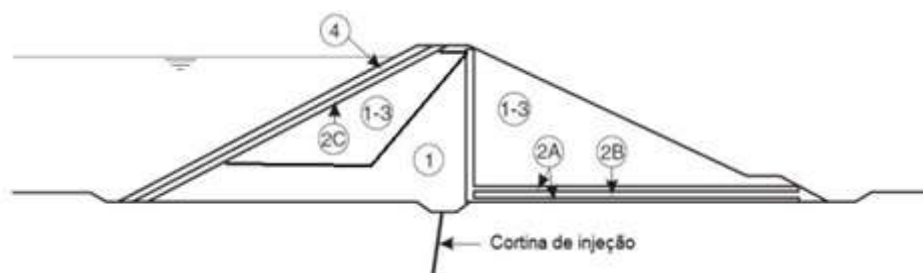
Seção da barragem de terra zoneada com filtro vertical e tapete horizontal e aplicação da cortina de injeção. Fonte: Melo (2014).
